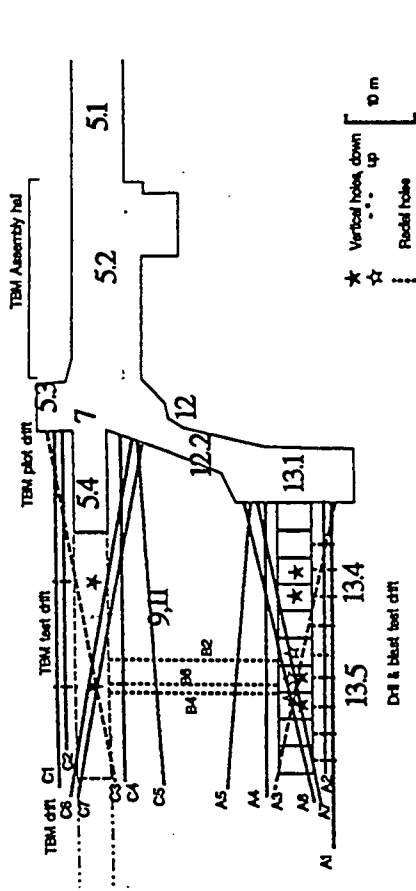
HRLの掘削計画と計測用ボーリング配置 (平面図)
